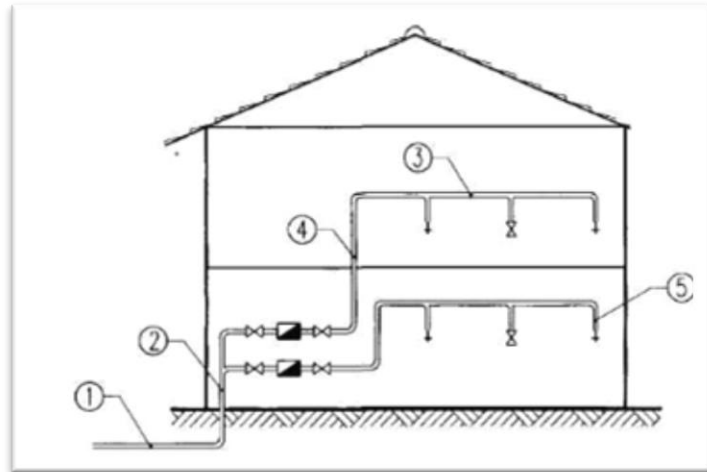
Elementos constituintes de uma rede de abastecimento de águas (Fonte – [14])
